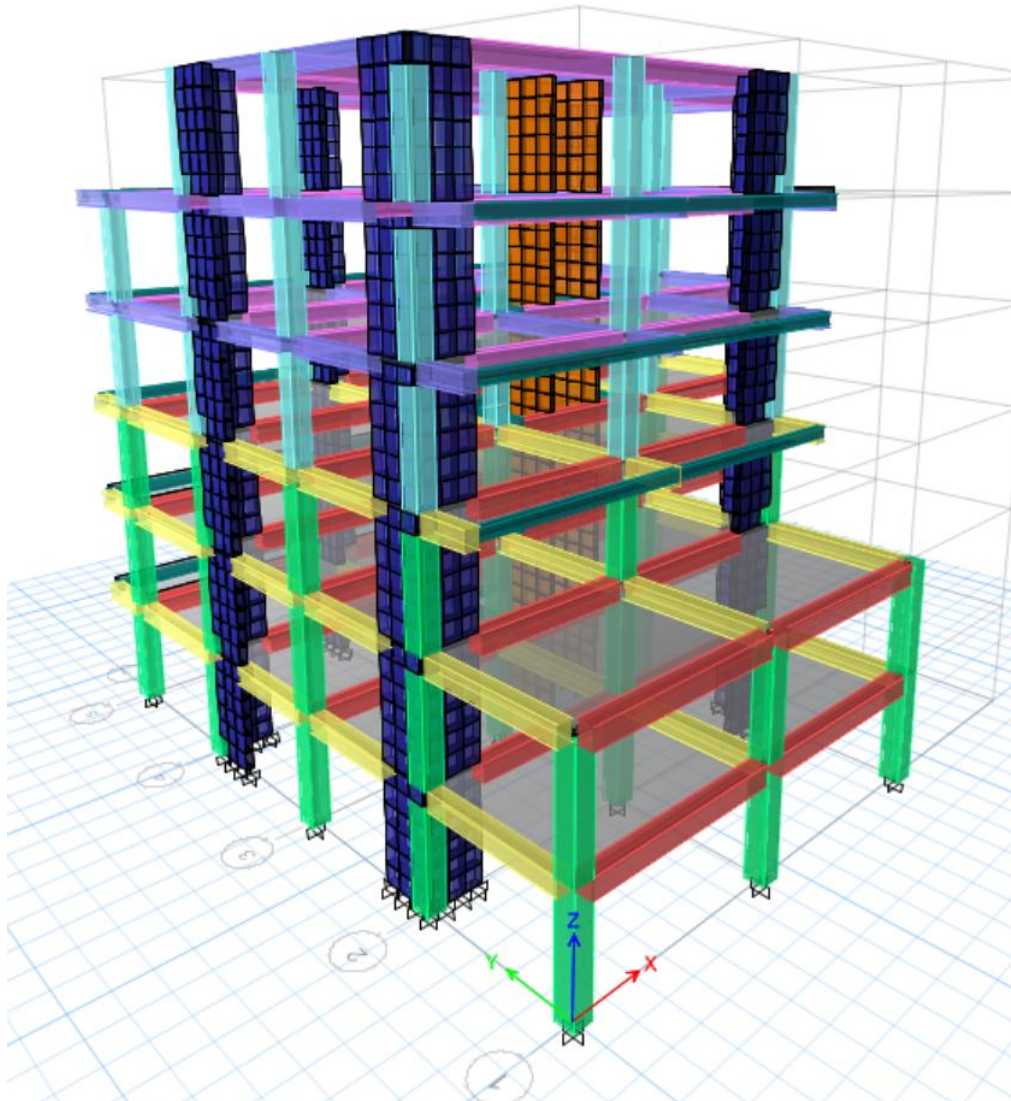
Sistema de pórticos de Hormigón Armado. Elaboración Propia (2025).
